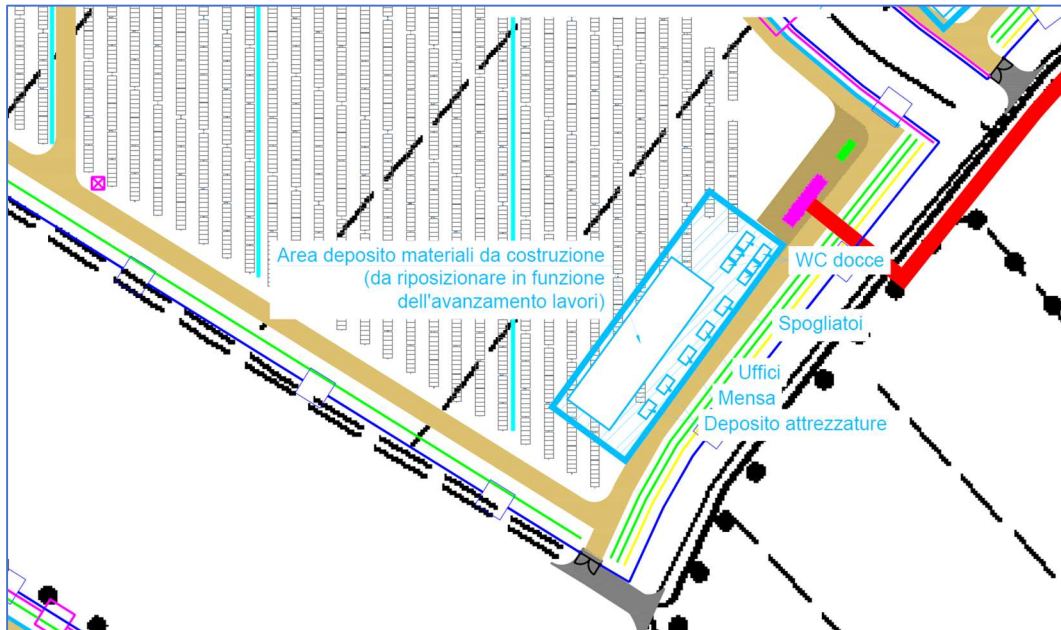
Individuazione delle aree con gli apprestamenti di cantiere (rispettivamente campi centrale e sud)
